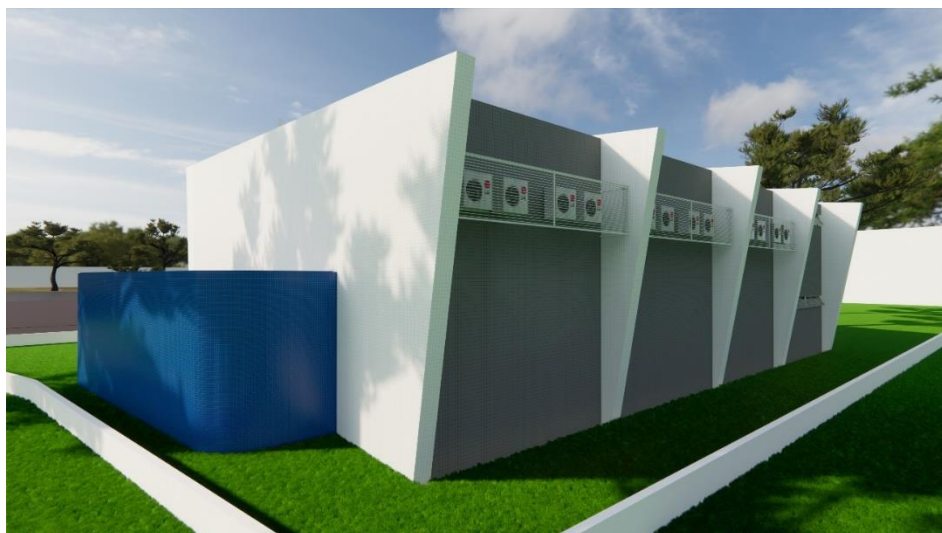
Fachadas Norte e Oeste. Fonte: Autora, 2024.
